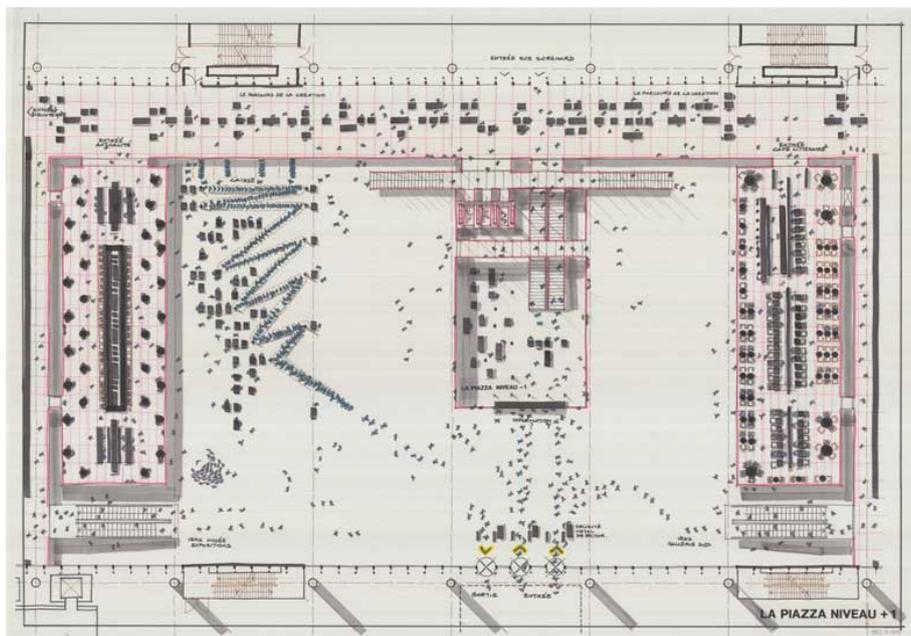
Dibujo Planta baja Centro Georges Pompidou. 1988.
